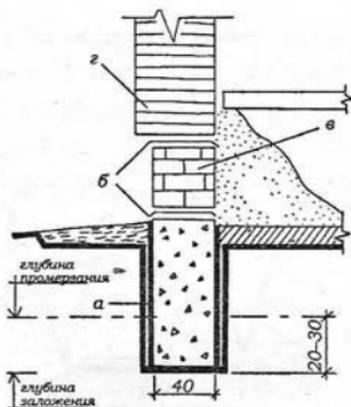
Устройство фундаментов при совпадении уровня грунтовых вод с глубиной промерзания (размеры в см):
